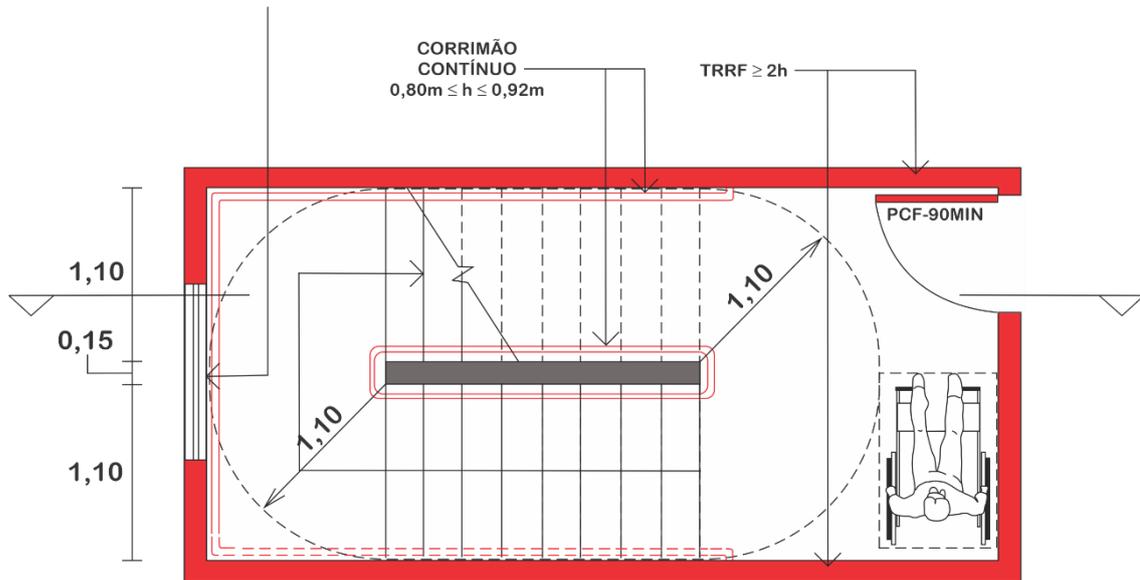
Escada Enclausurada Protegida (Pavimento Superior)
